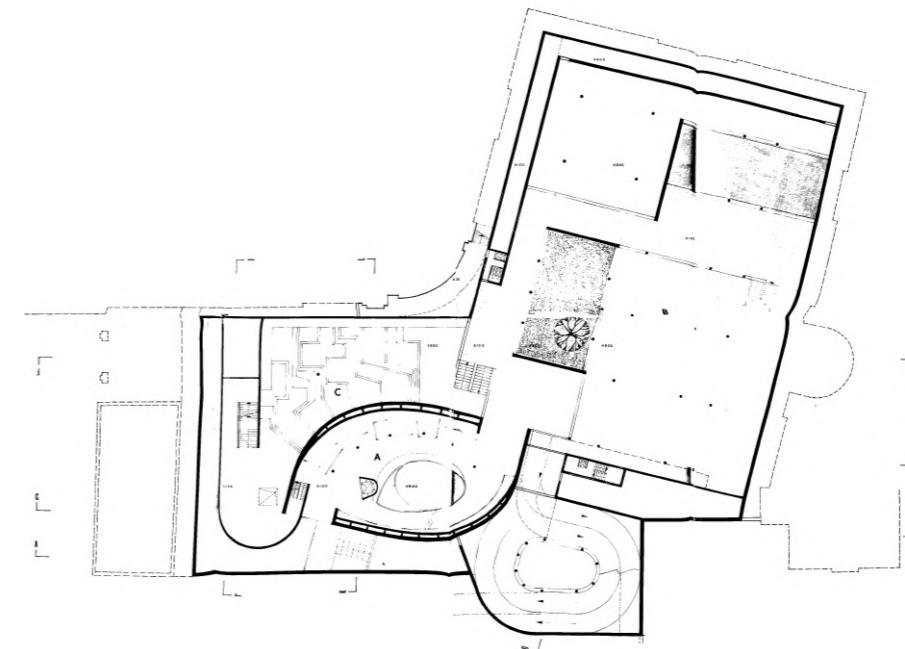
Plan de la mezzanine, 5^{ème} esquisse v1.
